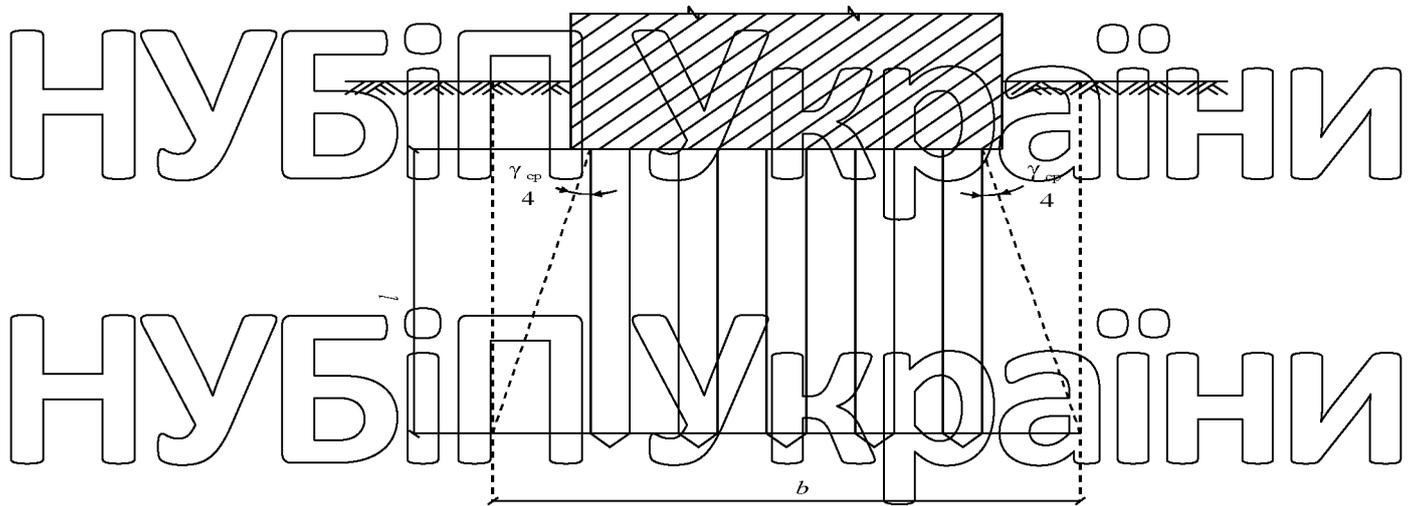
До визначення опору основи. Схема визначення умовного пального фундаменту
